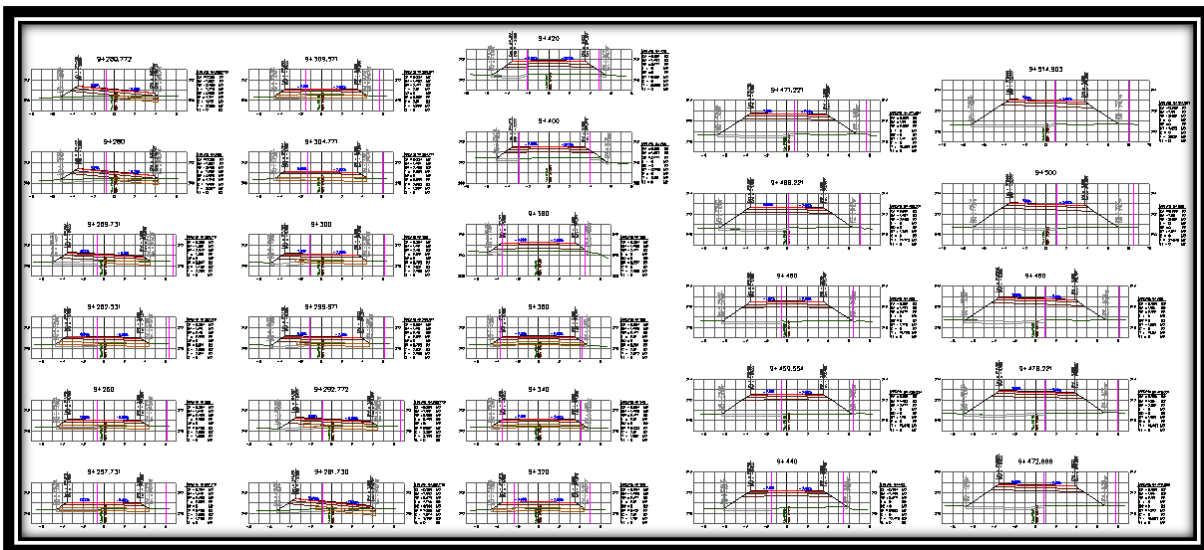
Secciones de construcción del km 9+257.731 al km 9+514.903.
